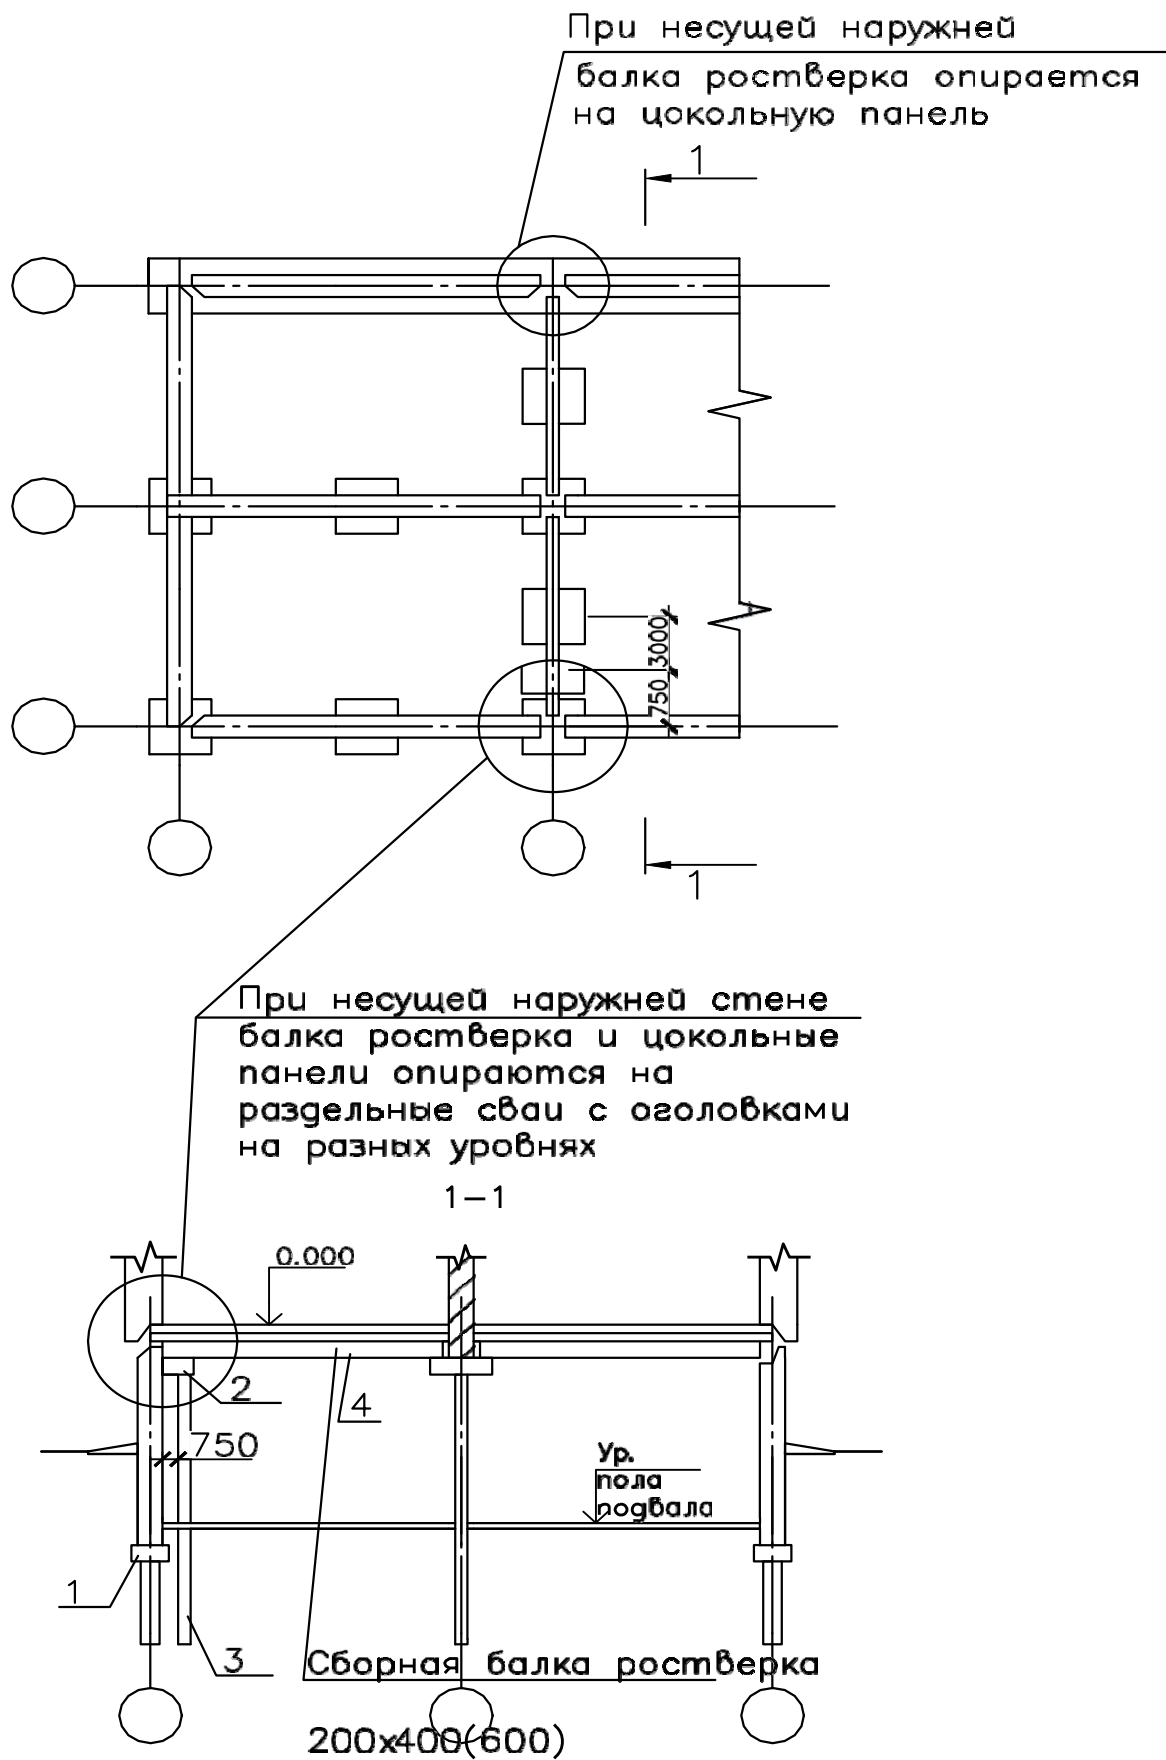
Схема свайного фундамента с высоким сборным ростверком:
